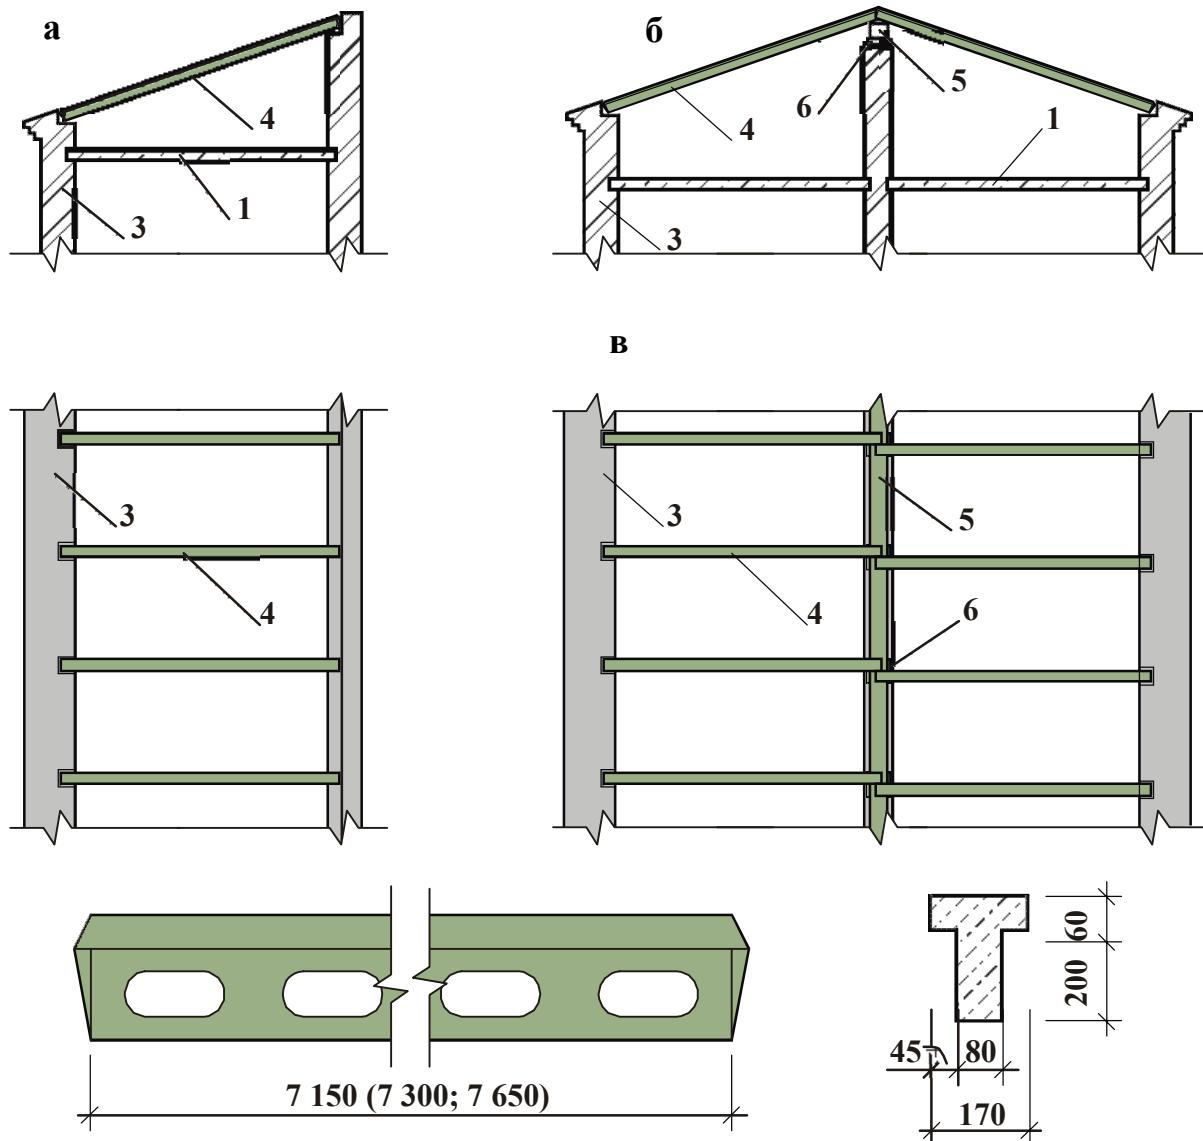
Збірний заливобетонний дах кроквяної конструкції:
